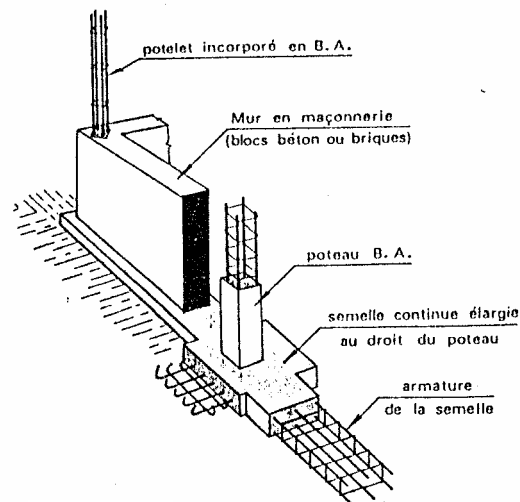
Armature d'une semelle continue sous poteaux B.A.
